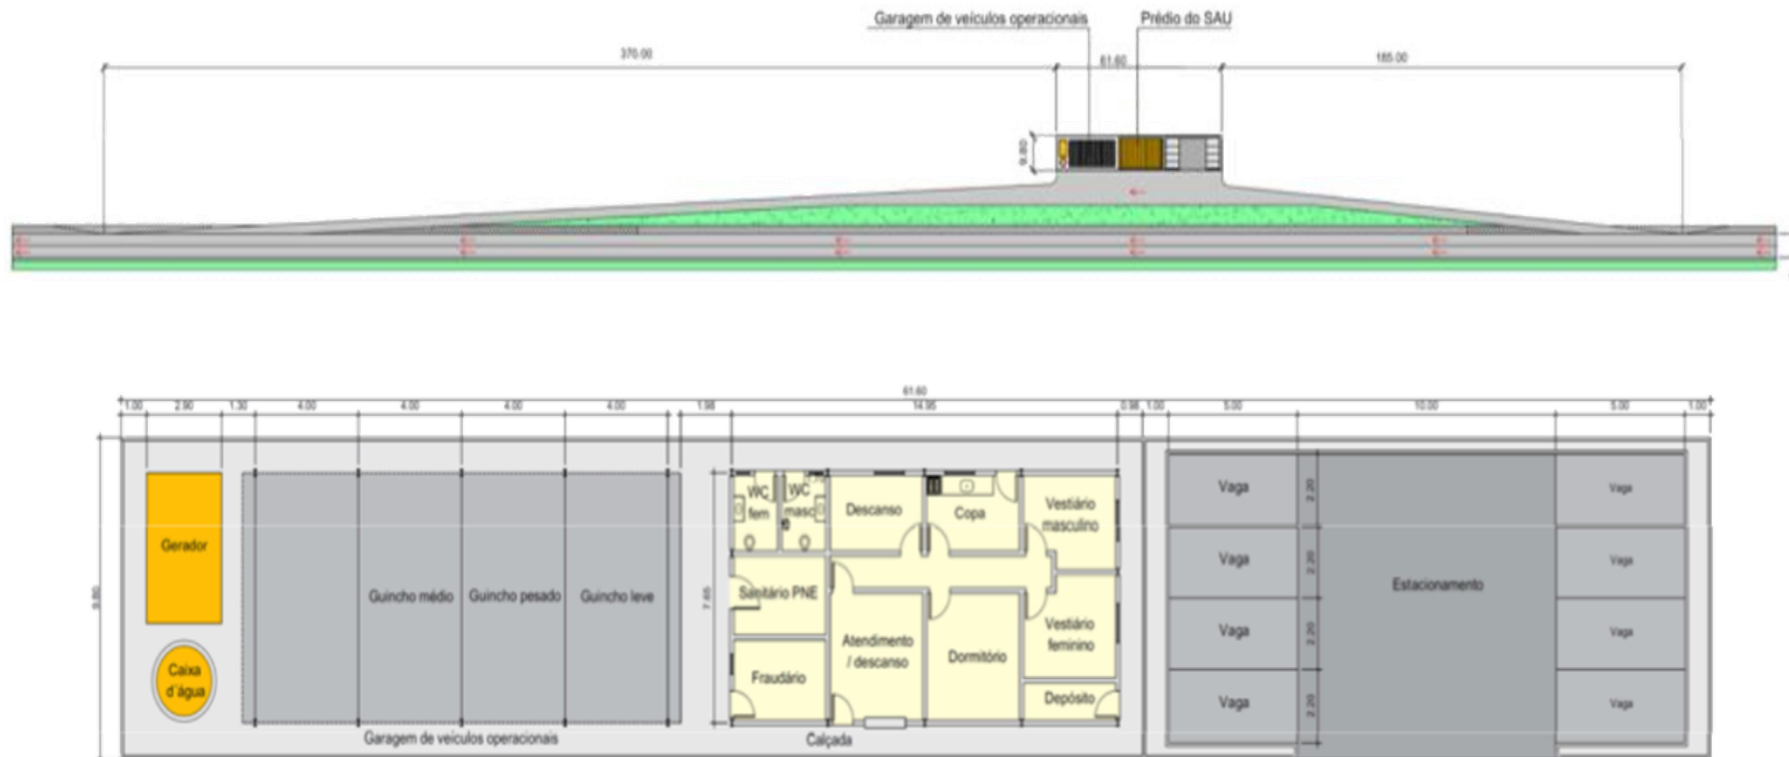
Exemplo de Planta Baixa - SAU.
